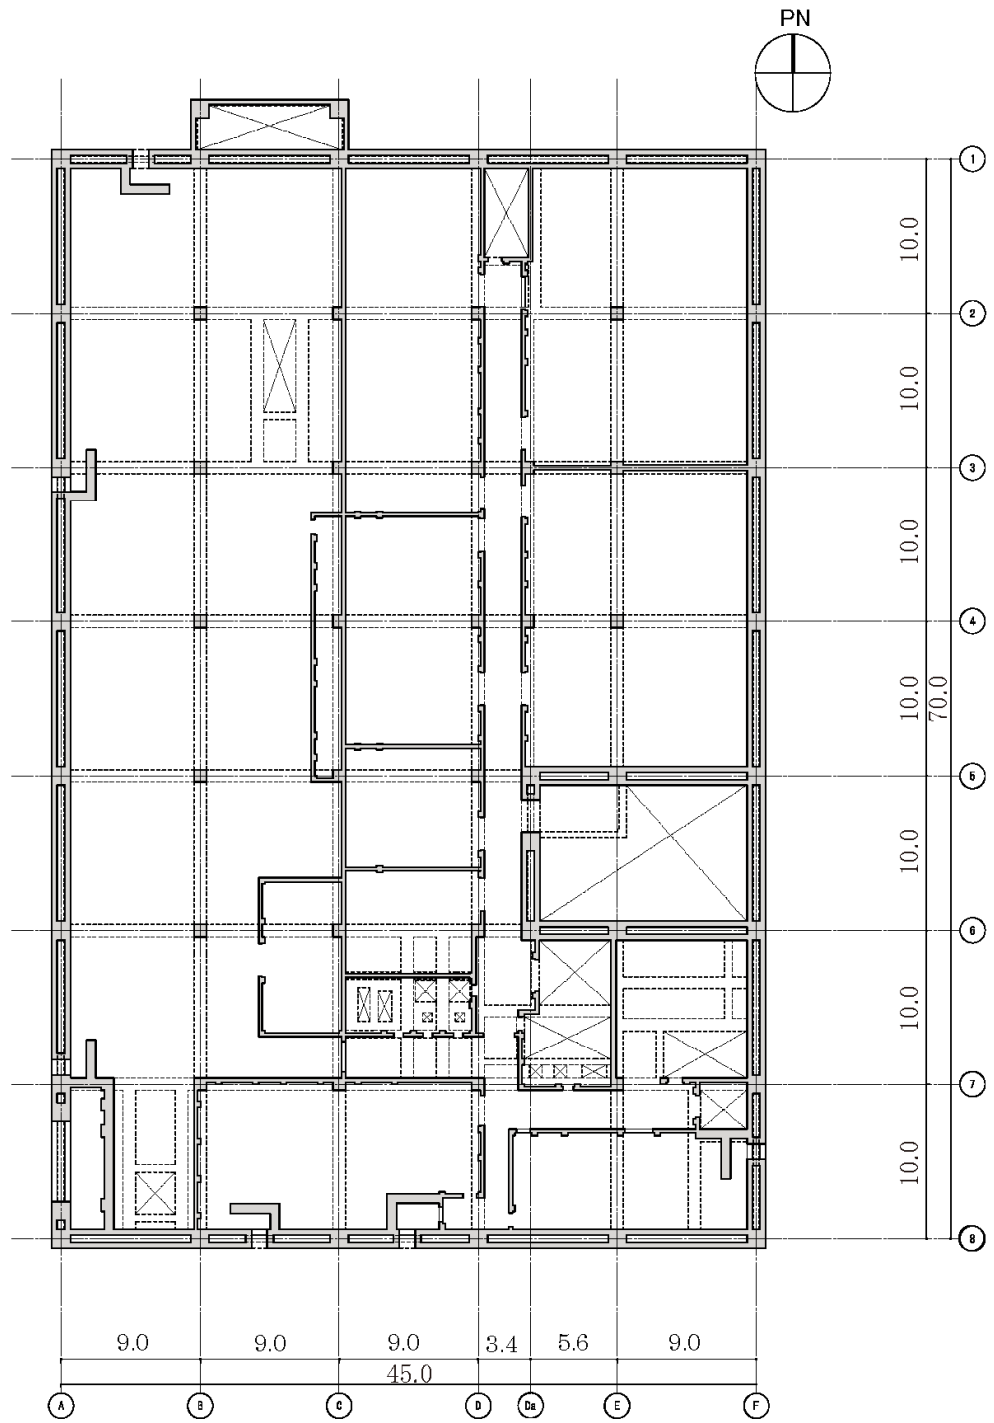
3階平面図 (G.L. +15.80) (単位 : m)
